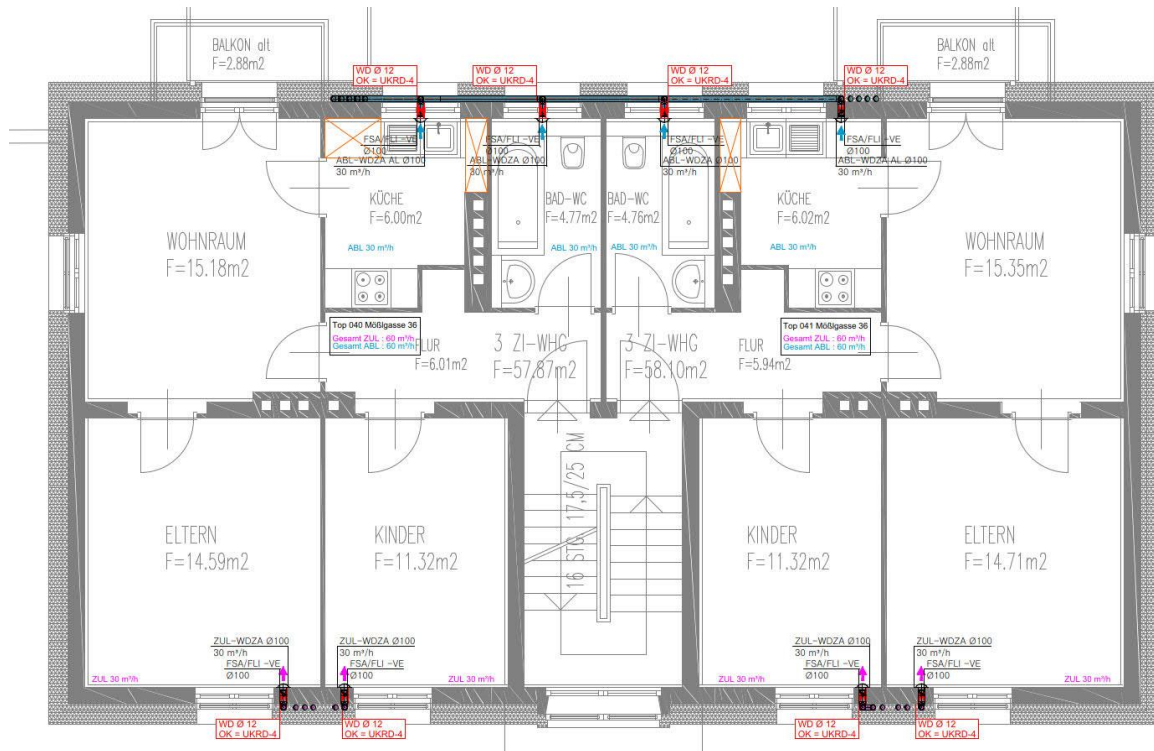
Grundriss Mößlgasse 36; Quelle: Alpsolar Klimadesign
